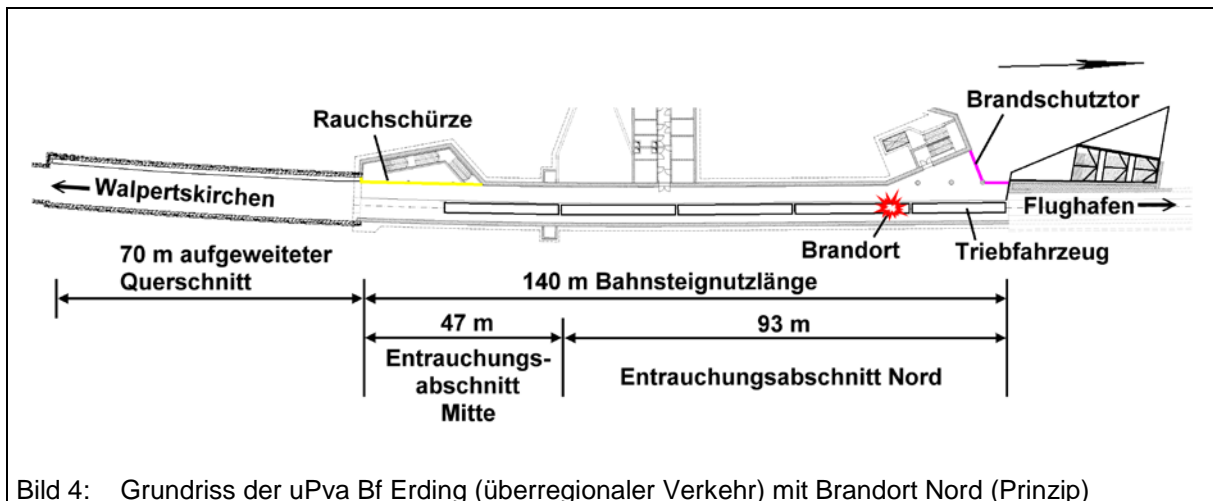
Grundriss der uPva Bf Erding (überregionaler Verkehr) mit Brandort Nord (Prinzip)
